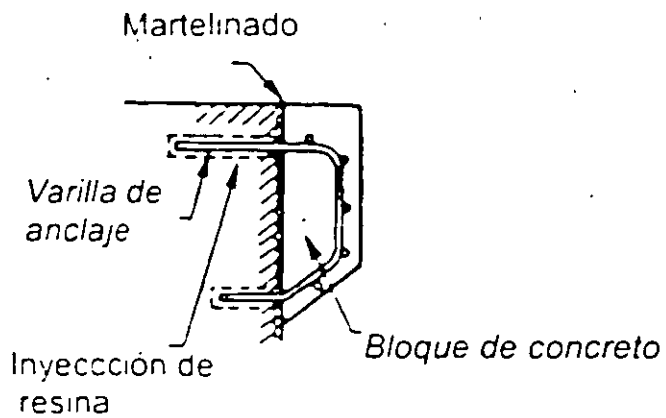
RESTRICCIÓN A LOS TABLEROS DE LA SUPERESTRUCTURA
